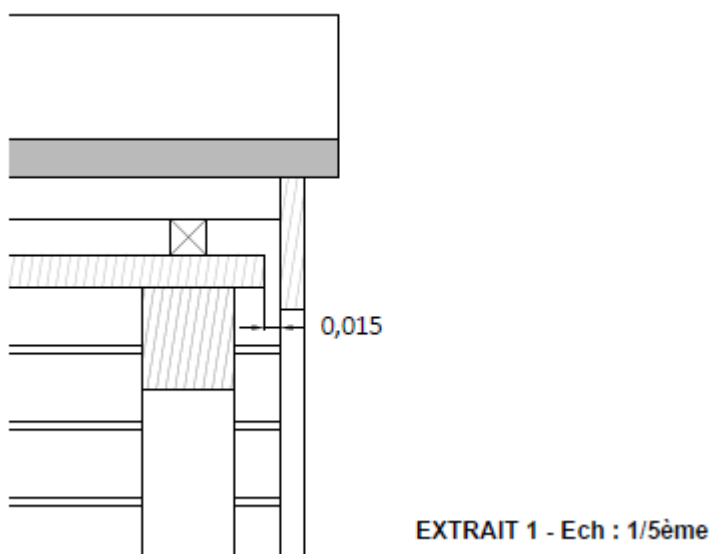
Plan de l'espace laissé entre les planches de rive et le chevron sur le bâtiment compensatoire (Source : CD54)
